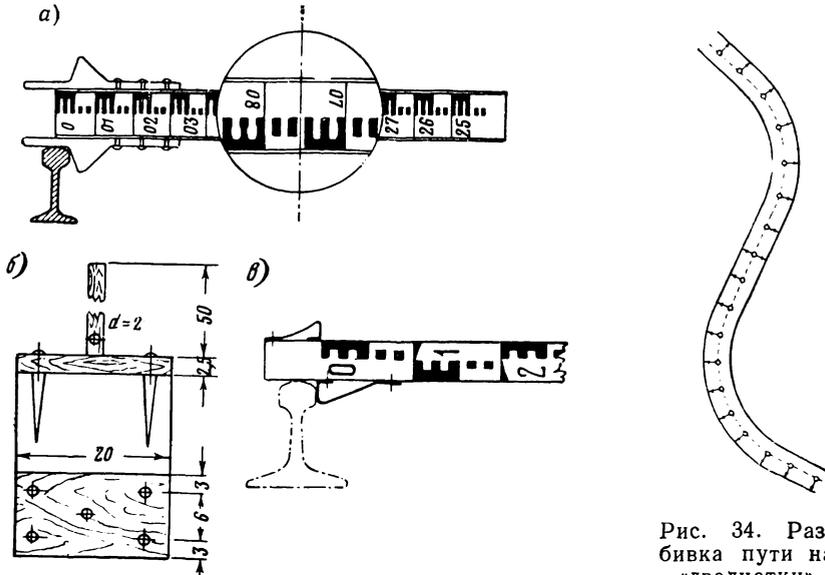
Башмак и рейка для съемки кривых: а—приспособление 3-м нивелировочной рейки для чтения стрел f (положение при съемке левой кривой); б—башмак для визирования (изготавливается из дерева); металлические башмаки не допускаются (по условиям безопасности движения поездов); в—приспособление рейки для съемки ординат от секущих
